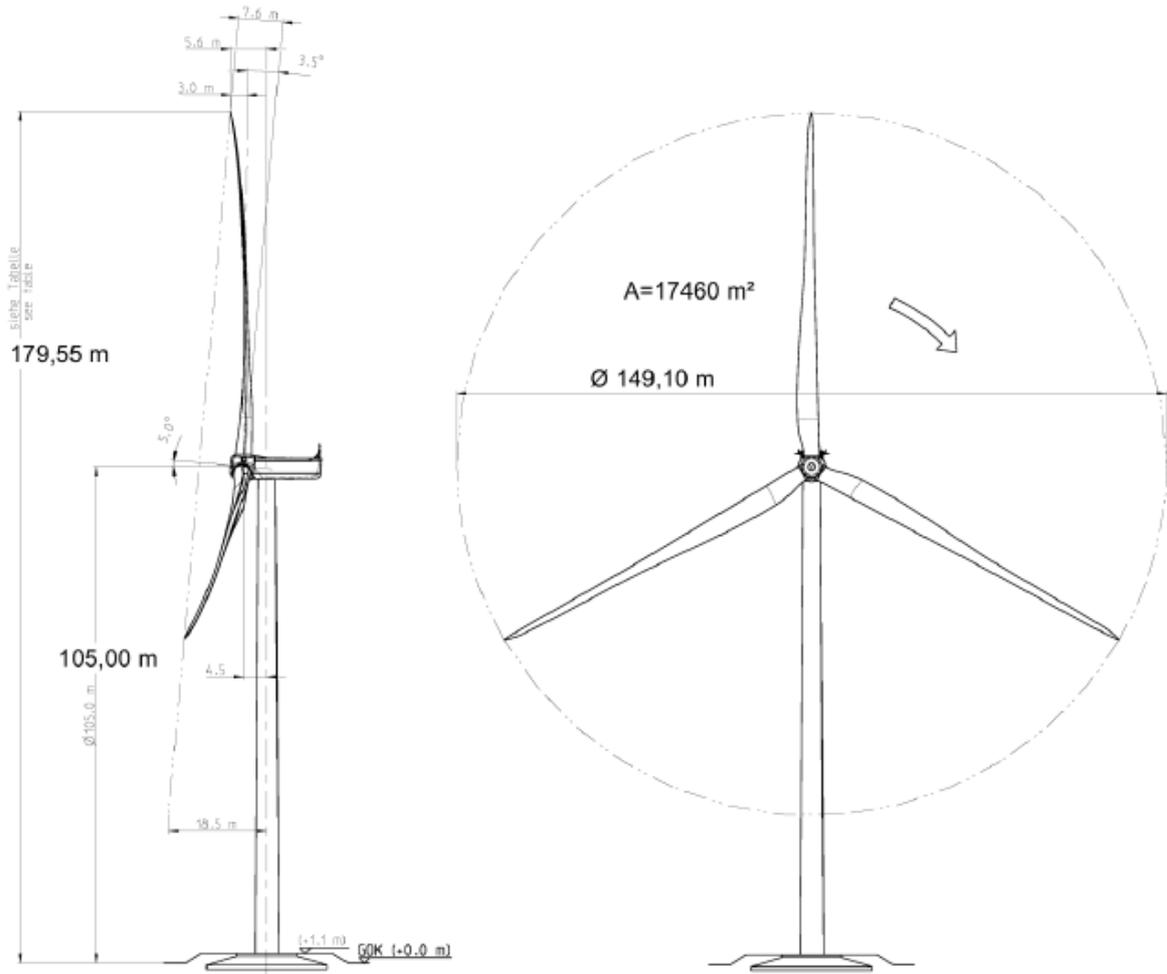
Plan en élévation de l'éolienne NORDEX N149/5700 TS105
